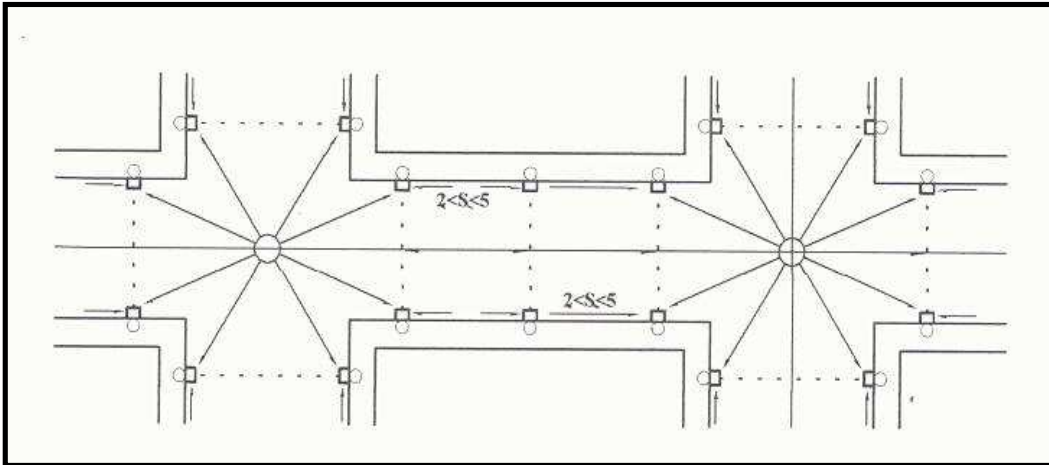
Ubicación de coladeras de piso y banqueta.
